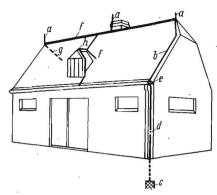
Schematische Darstellung einer Blitzschutzanlage auf einem Futterhaus. a Auffangstangen, b Gebäudeleitungen, c Erder, d Treunstelle, e Dachrinne (angeschlossen), f Dachkehle (angeschlossen), g Ableitung zur anderen Gebäudeseite, h Dachausbau (geschützt). Aus: Leitfaden für die Arbeit im vorbeugenden Brandschutz, Teil III, S. 16 (zum Teil verändert)
